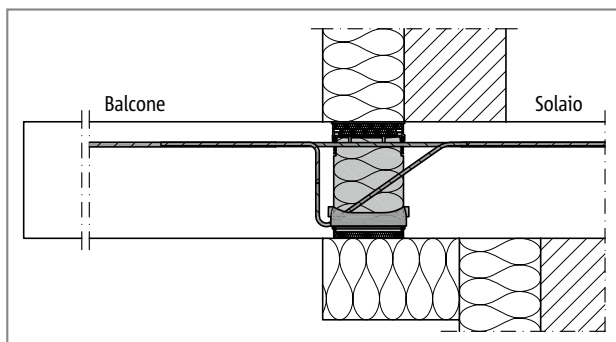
Schöck Isokorb® XT tipo KL: raccordo indiretto al solaio e cappotto
